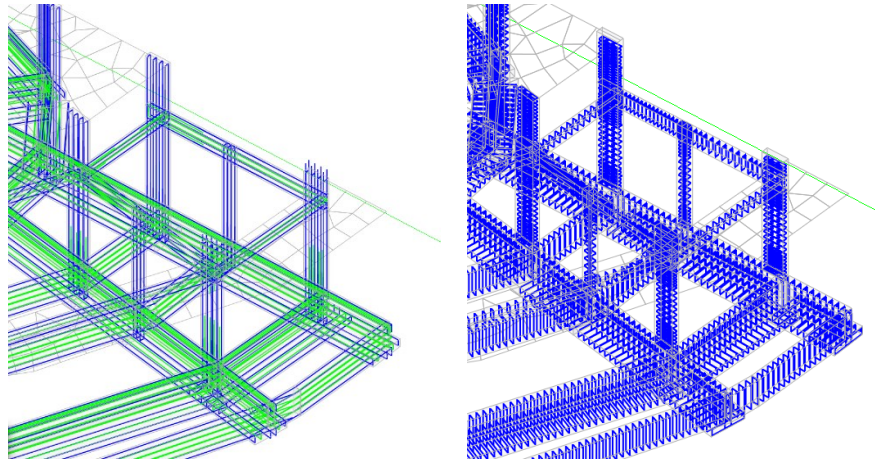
Dettaglio delle armature assegnate agli elementi in una porzione di struttura
